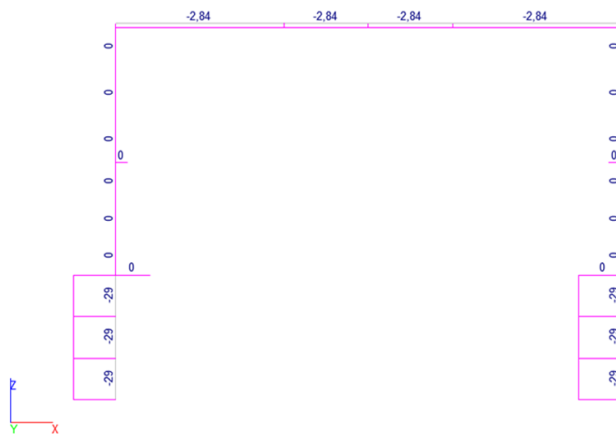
Эпюра продольных усилий от веса кладки, кН
